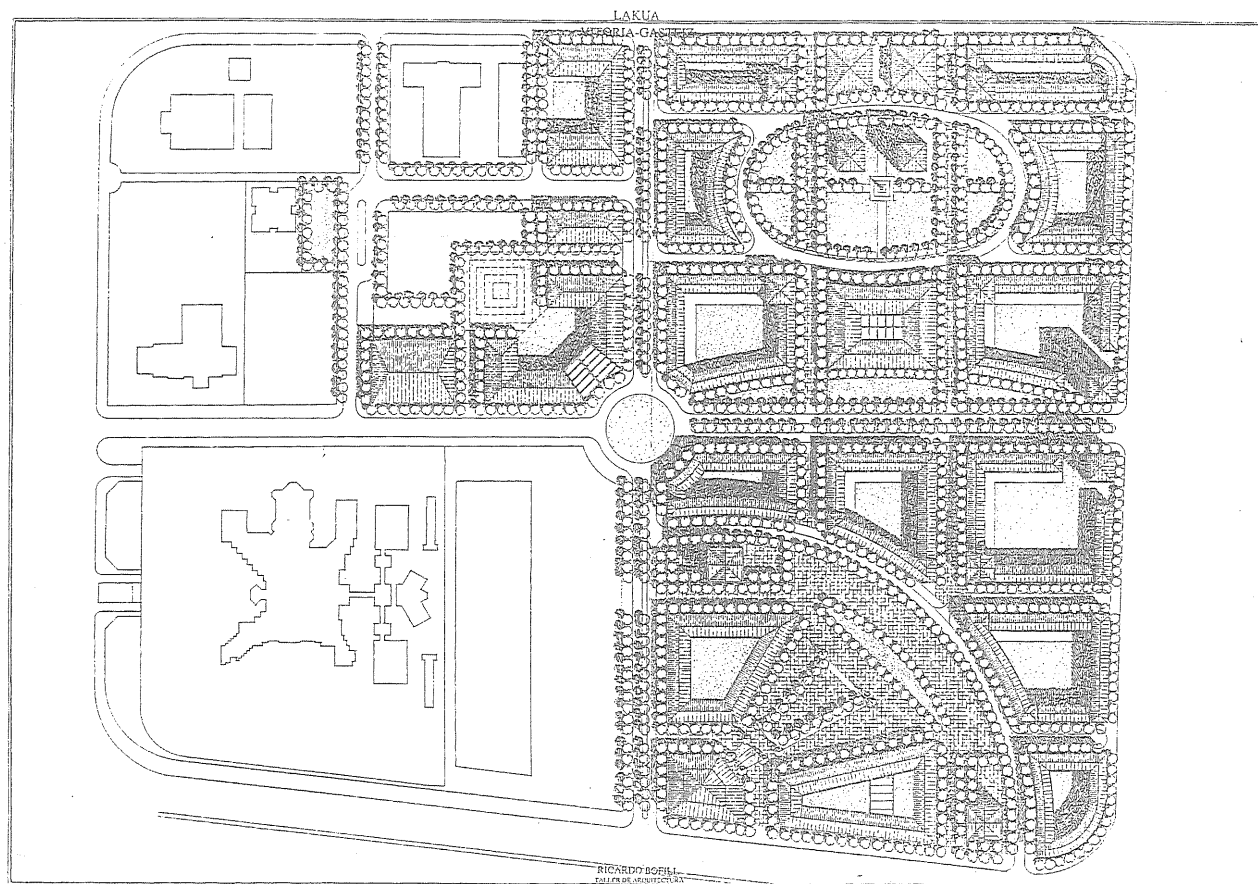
Modificación del Plan Parcial del Sector 2 de Lakua, junio 1993 (Taller de Arquitectura de R. Bofill). A diferencia del Plan Parcial de 1985, ahora se va a una ordenación volumétrica única y vinculante desde el propio planeamiento, lo que supondrá un pesado condicionamiento para la arquitectura posterior. Se dibujan manzanas cerradas o semicerradas de distintas geometrías y tamaños, alturas de cada cuerpo edificado, torres exentas o torretas que señalan las esquinas, etc.
